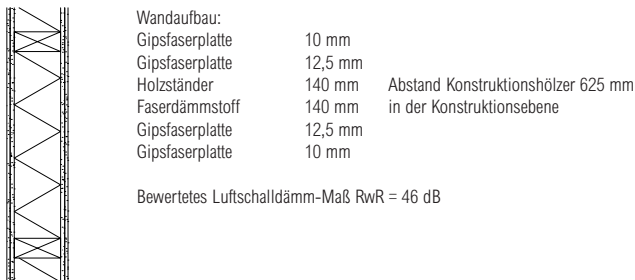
Aufbau einer einfachen Holzständerinnenwand mit doppelter Beplankung
